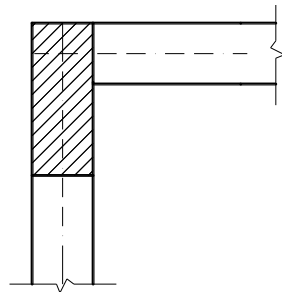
Arranjo estrutural do pilar na planta de fôrma e dimensões da seção transversal.
